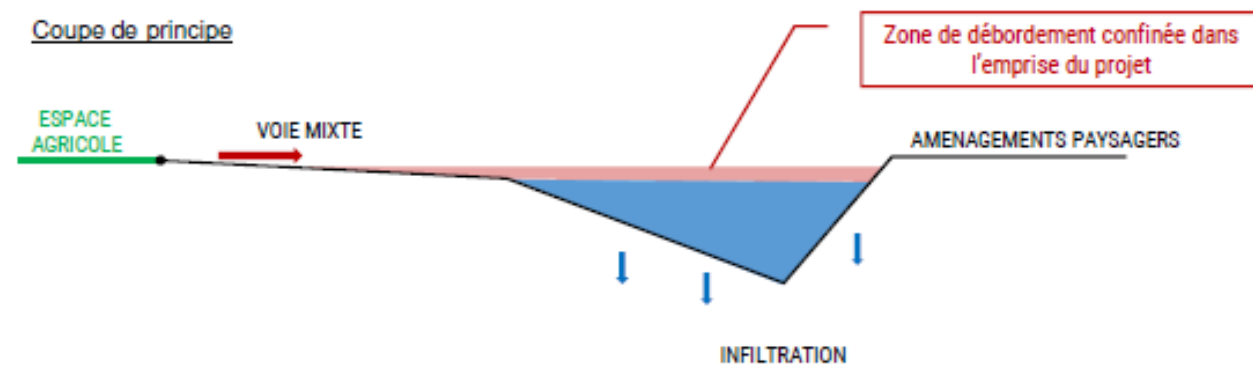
Coupe de principe de l'assainissement de la voie mixte
